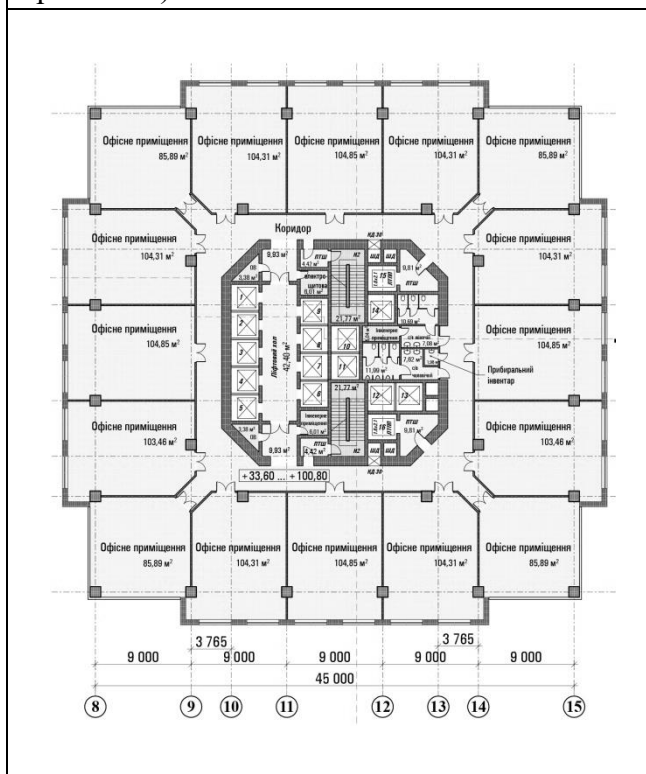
План типового офісного поверху БФЖК. Проект. (Авторське креслення)
